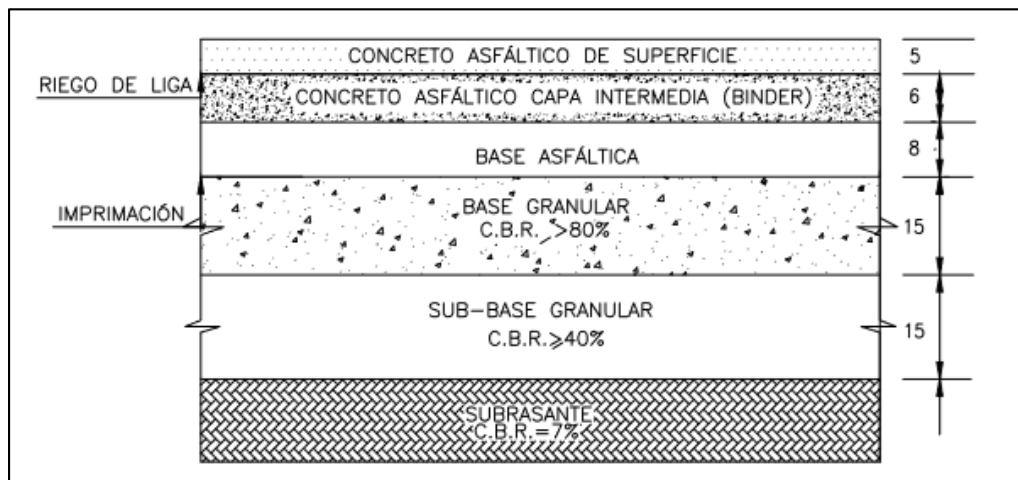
Perfil longitudinal del paquete estructural de la Ruta F-50.
